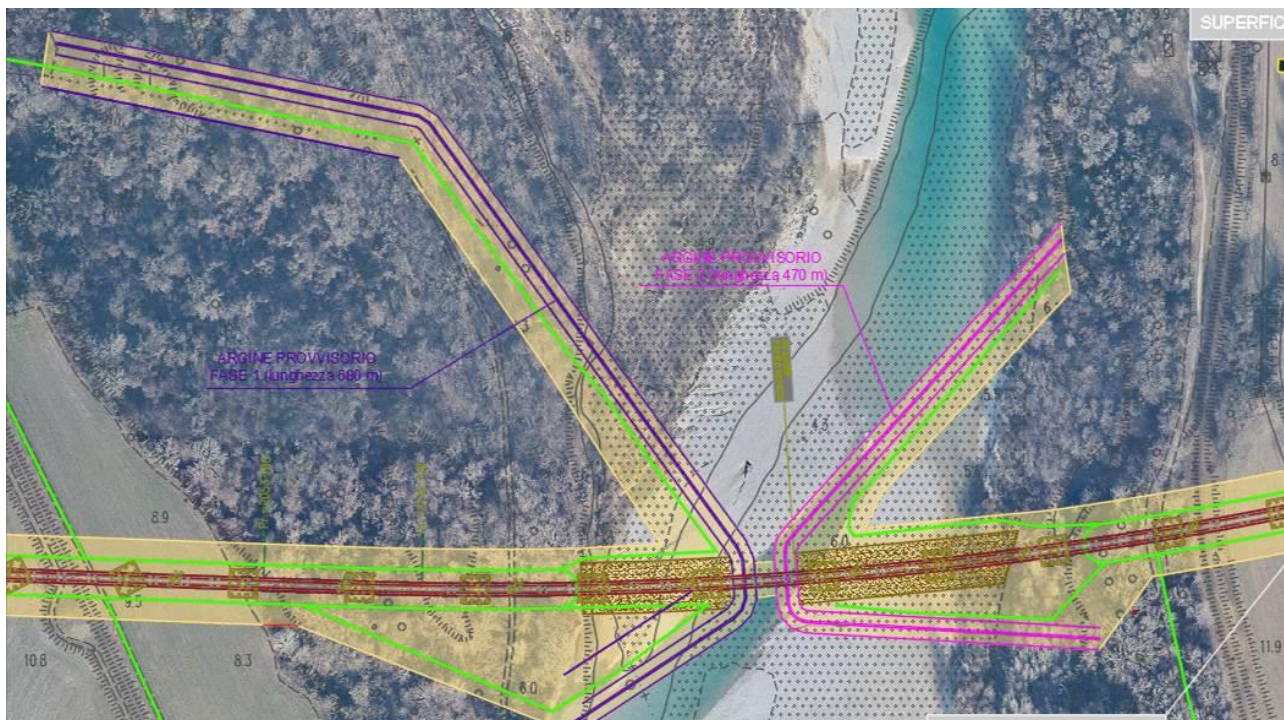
Area di lavoro prevista sul viadotto Isonzo
